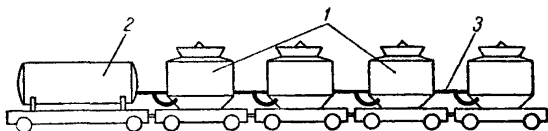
Транспортирование бетонной смеси в тоннель в передвижных пневмобетонагнетателях:
